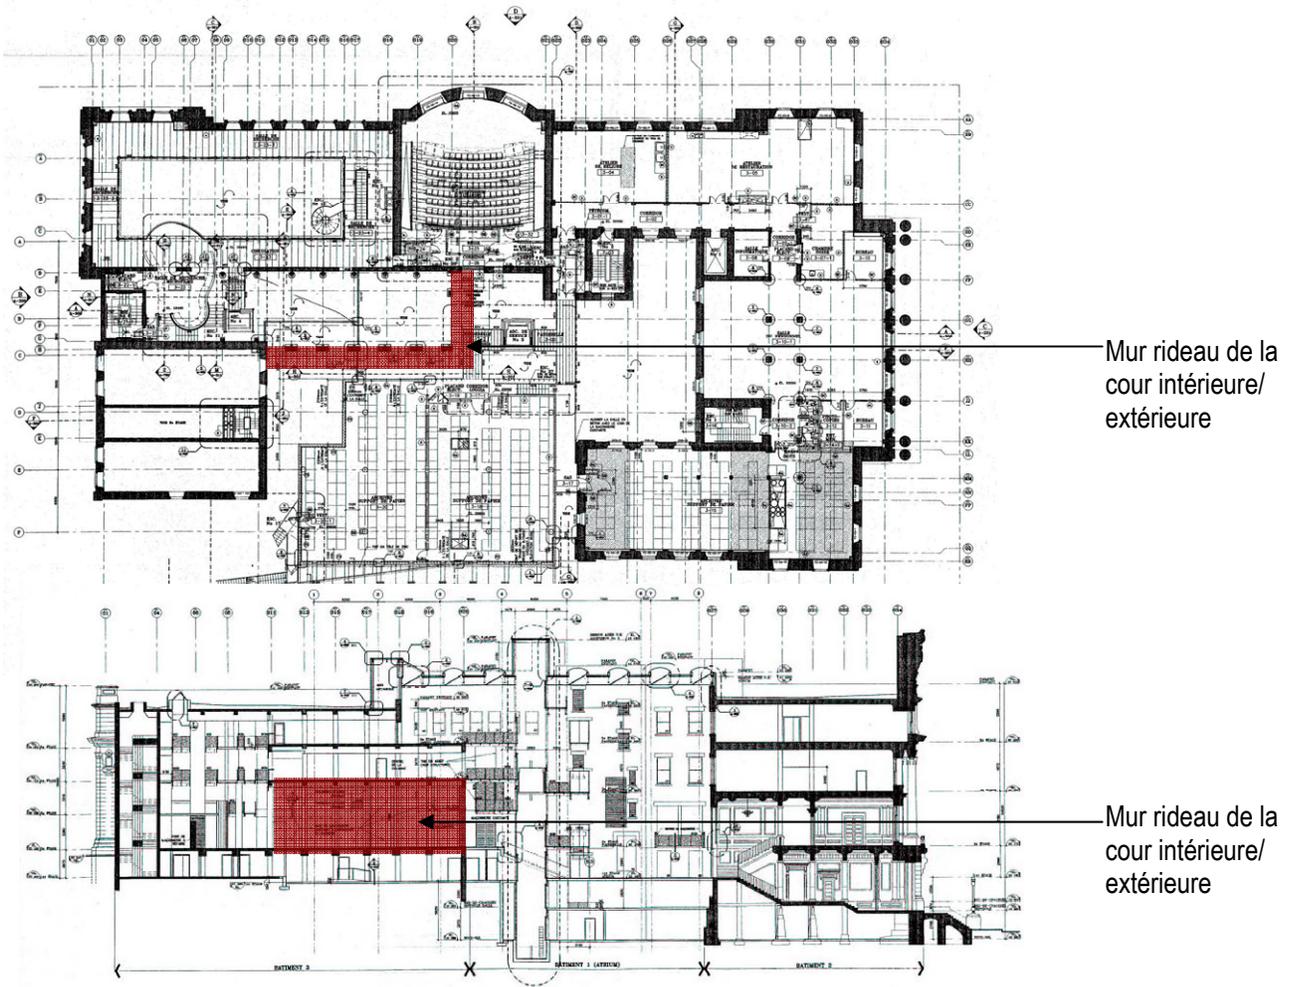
(A) Situation en plan et (B) en coupe du détail étudié (Source: Dan S. Hanganu Architectes)
